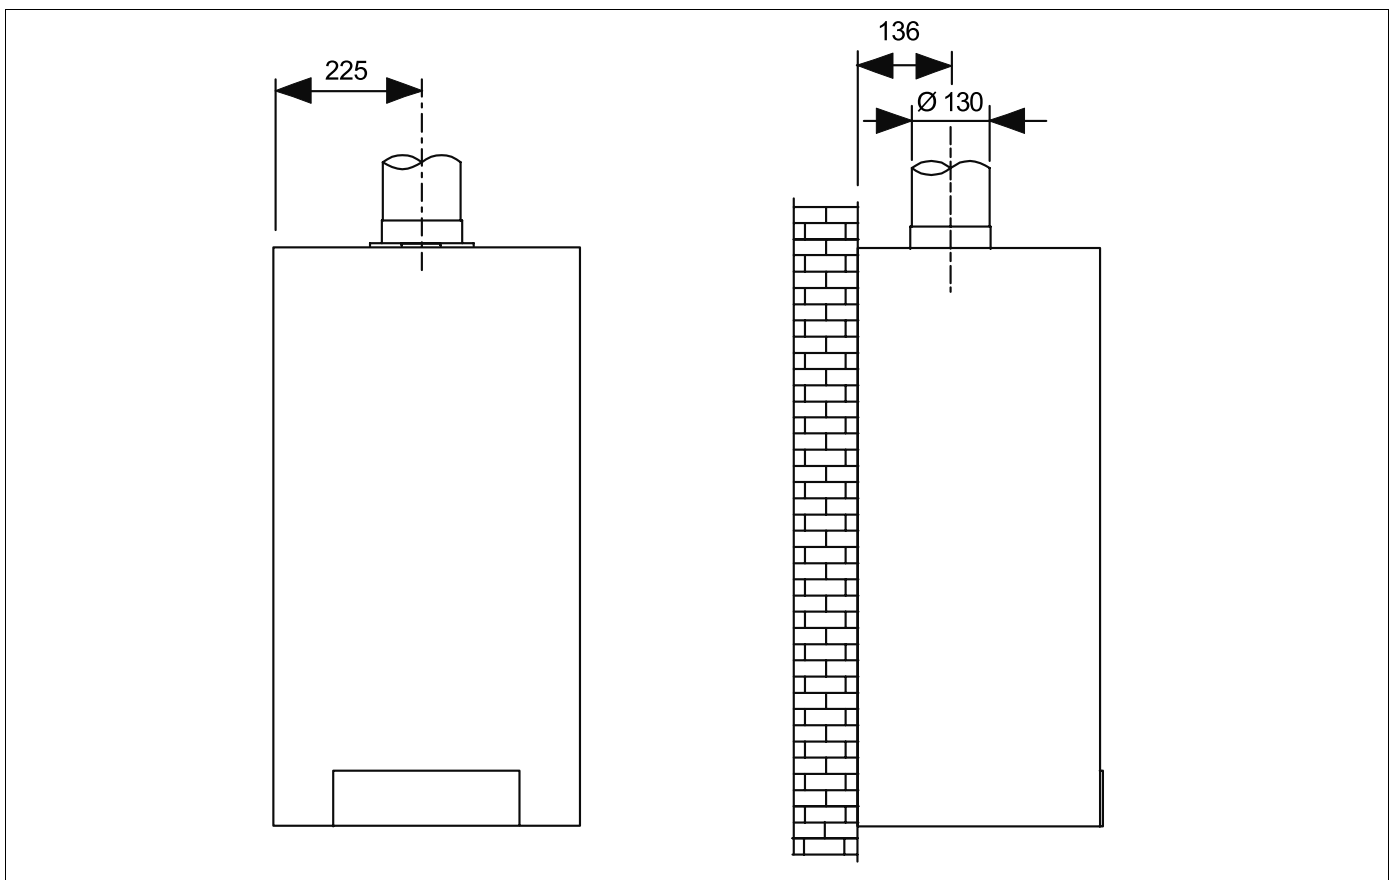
Dimensioni per il collegamento della conduttura di scarico fumi (misure in mm)
